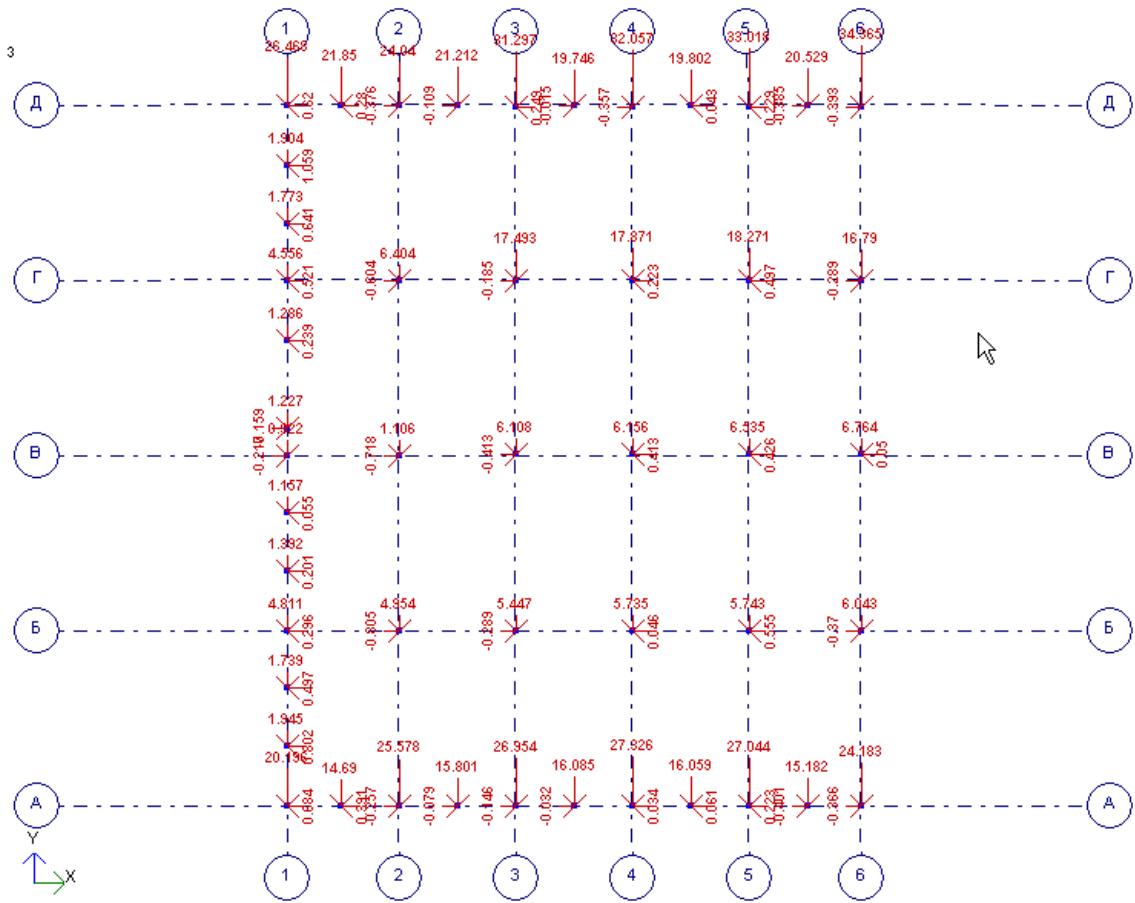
Навантаження на фундаменти (кН) за наслідками РСН
